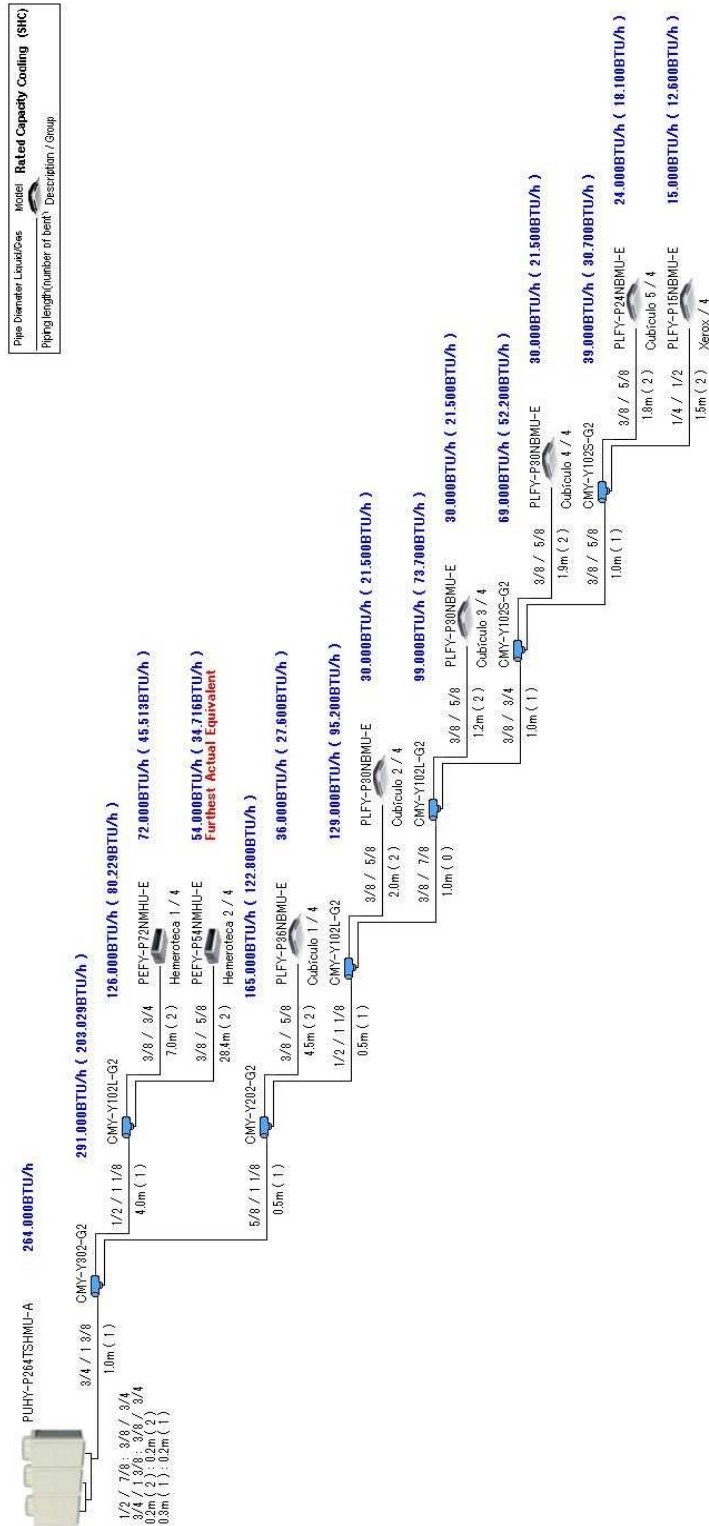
Sistema de Aire Acondicionado Planta Alta 2
